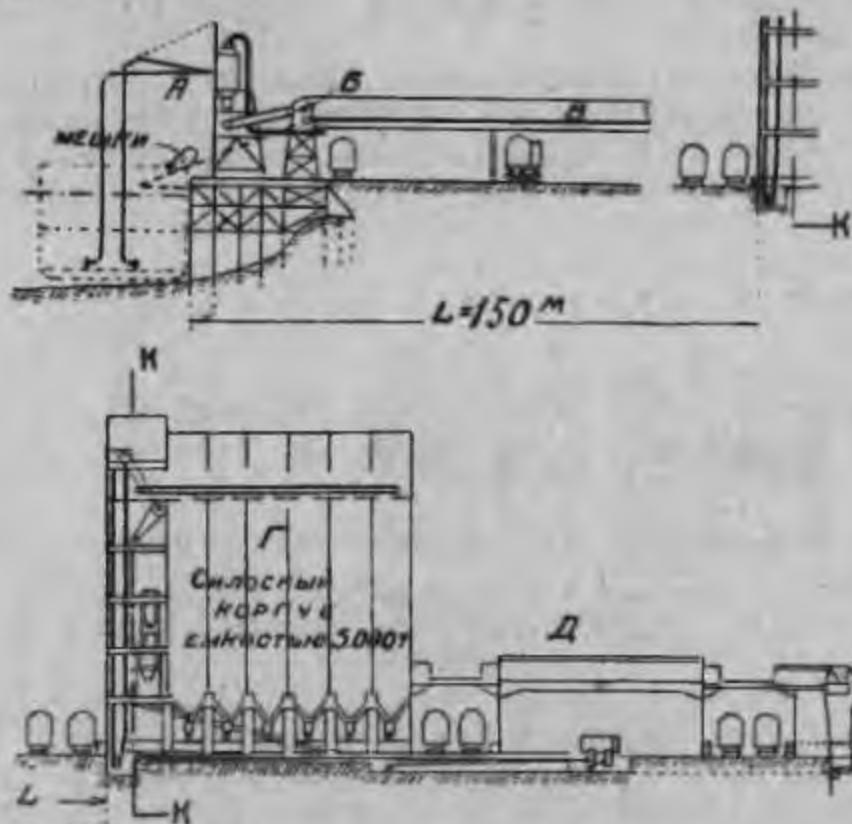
Комбинированная схема пневматической установки (А) для подъема зерна из судна в транспортерной ленты (Б—Б) для подачи зерна в элеватор (Г).
